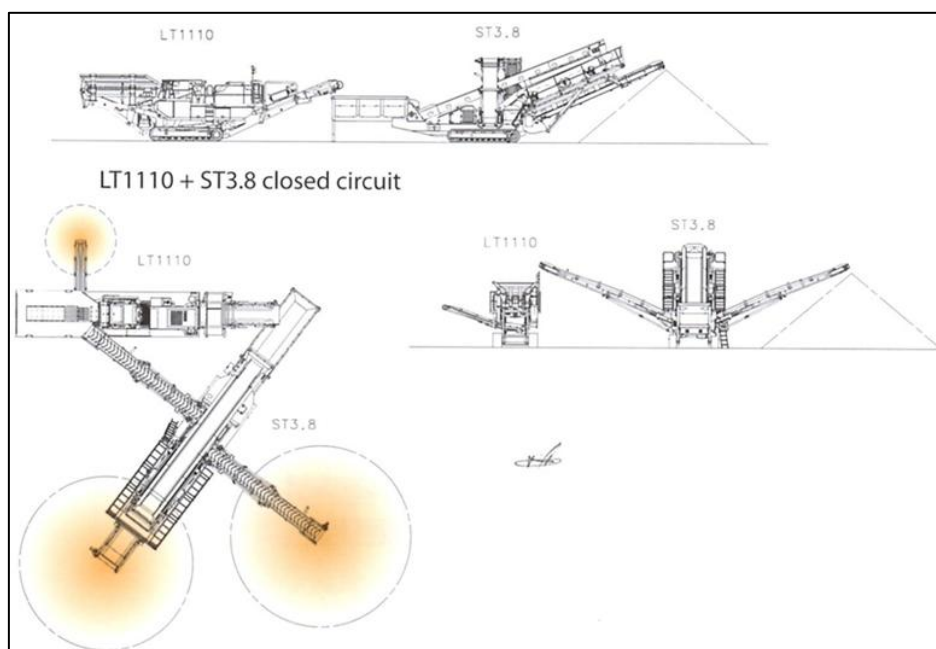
Plano de planta- Planta de reciclaje piloto. Producción estimada 150 TNH (metso 2011)
